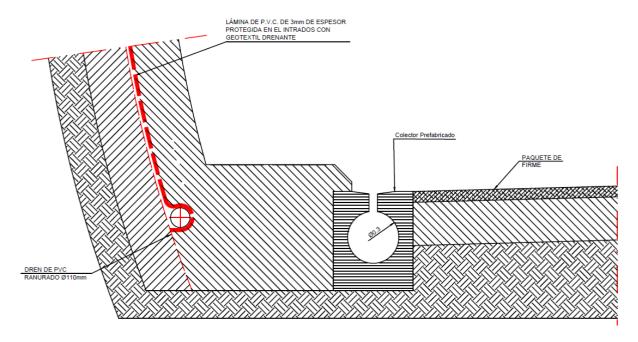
Detalle impermeabilización. Elaboración Propia
